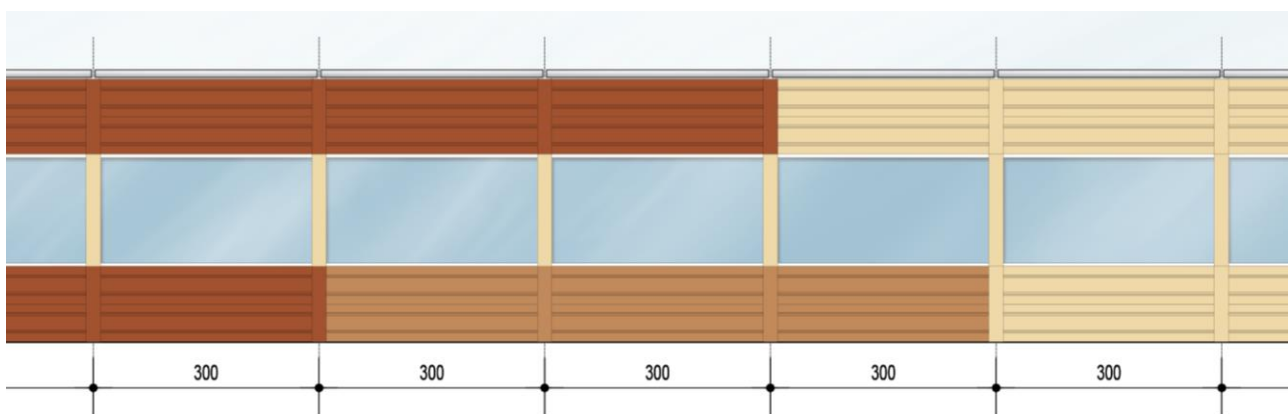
BARRIERA ACUSTICA MISTA FONOASSORBENTE-FONOSOLANTE – PROSPETTO LATO SORGENTE
